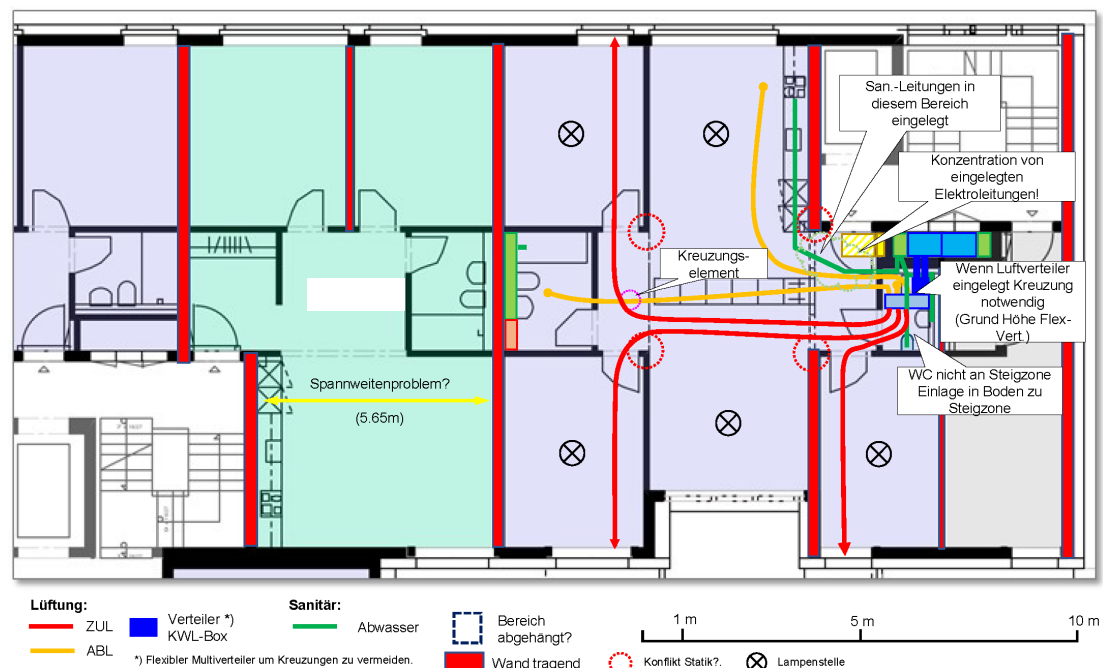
schematischer Grundriss zur Variante 0 «Sämtliche Gebäudetechnikleitungen eingelegt»
